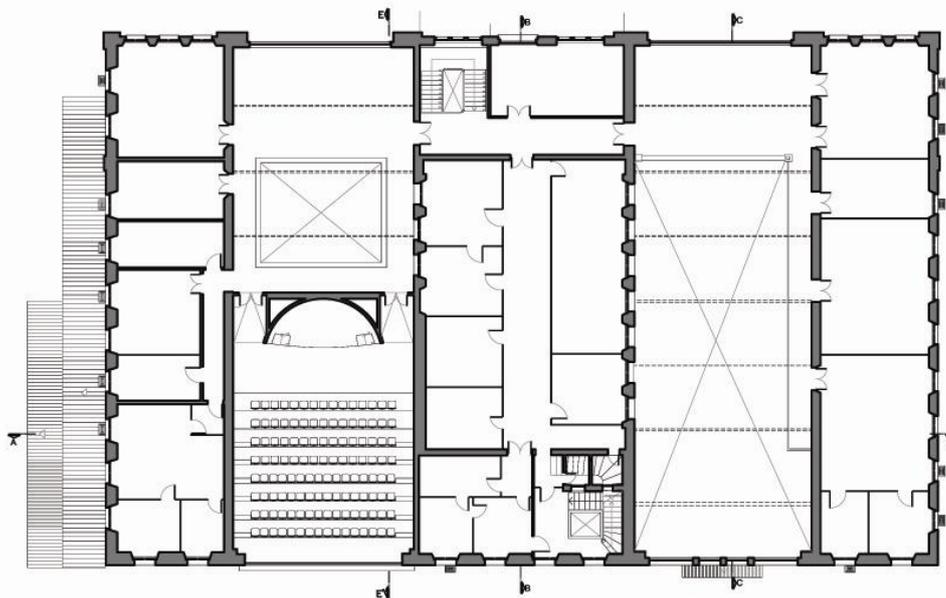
Planta de Cadastro do 2º pavimento– Situação antes da intervenção
